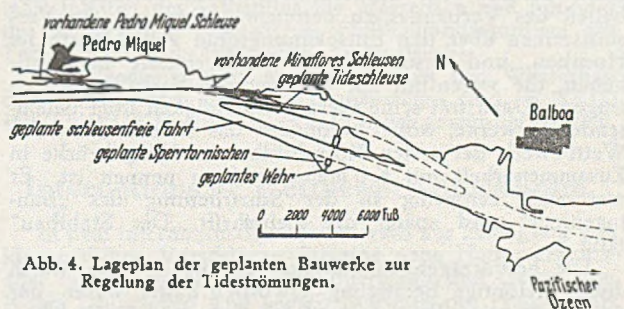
Lageplan der geplanten Bauwerke zur Regelung der Tideströmungen.
